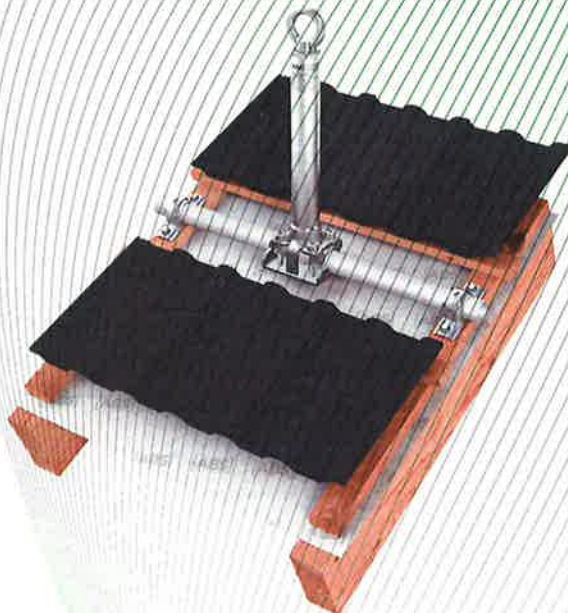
Dispositif d'ancrage, type : ABS-Lock® SD (exemple de montage)
